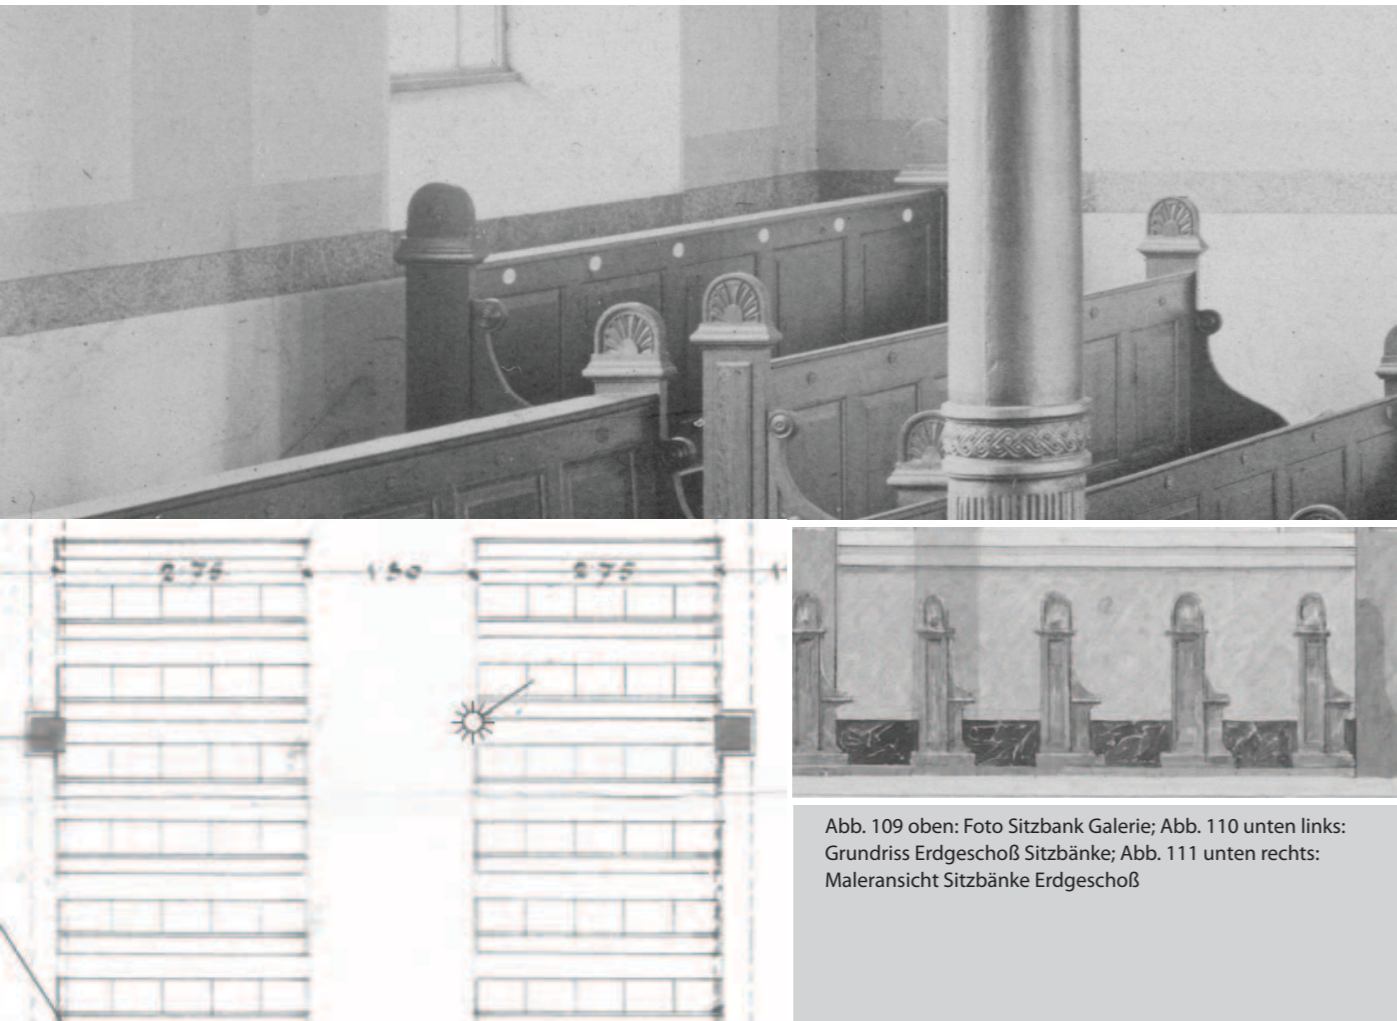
oben: Foto Sitzbank Galerie; Abb. 110 unten links: Grundriss Erdgeschoß Sitzbänke; Abb. 111 unten rechts: Maleransicht Sitzbänke Erdgeschoß
